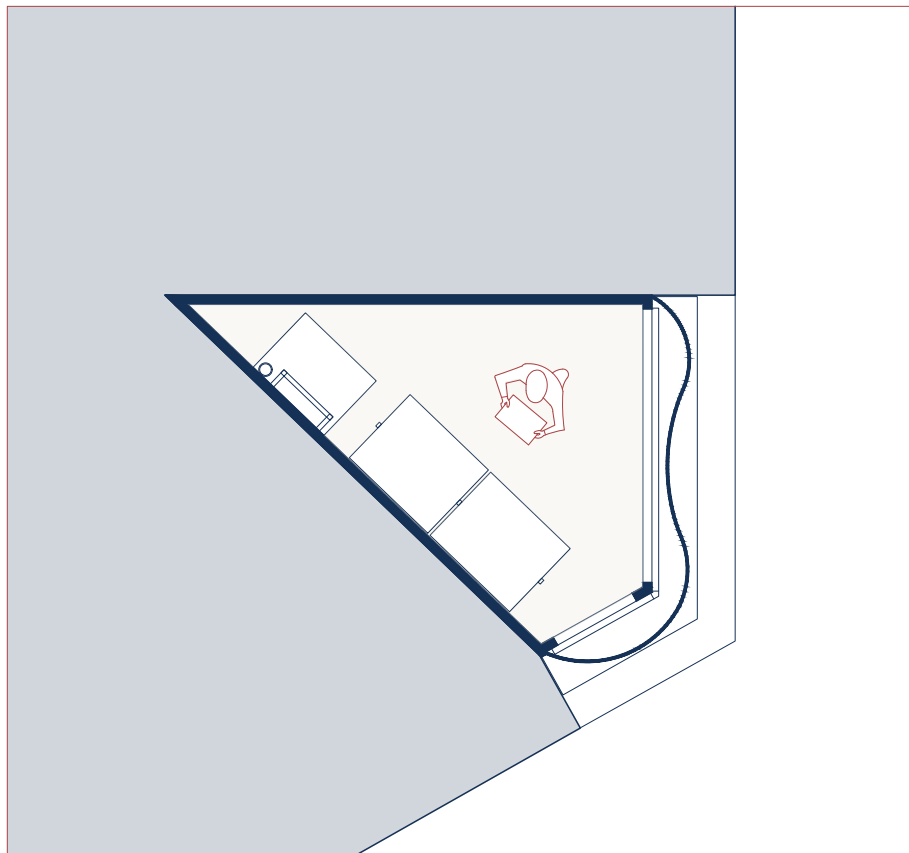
Pianta piano secondo, Rielaborazione propria - scala 1:50
